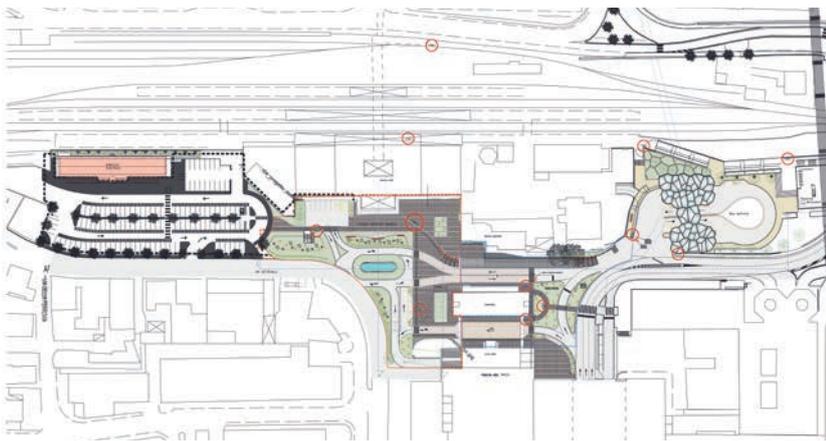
Planimetria degli interventi con l'individuazione delle aree di inserimento degli elementi progettuali del wayfinding.
